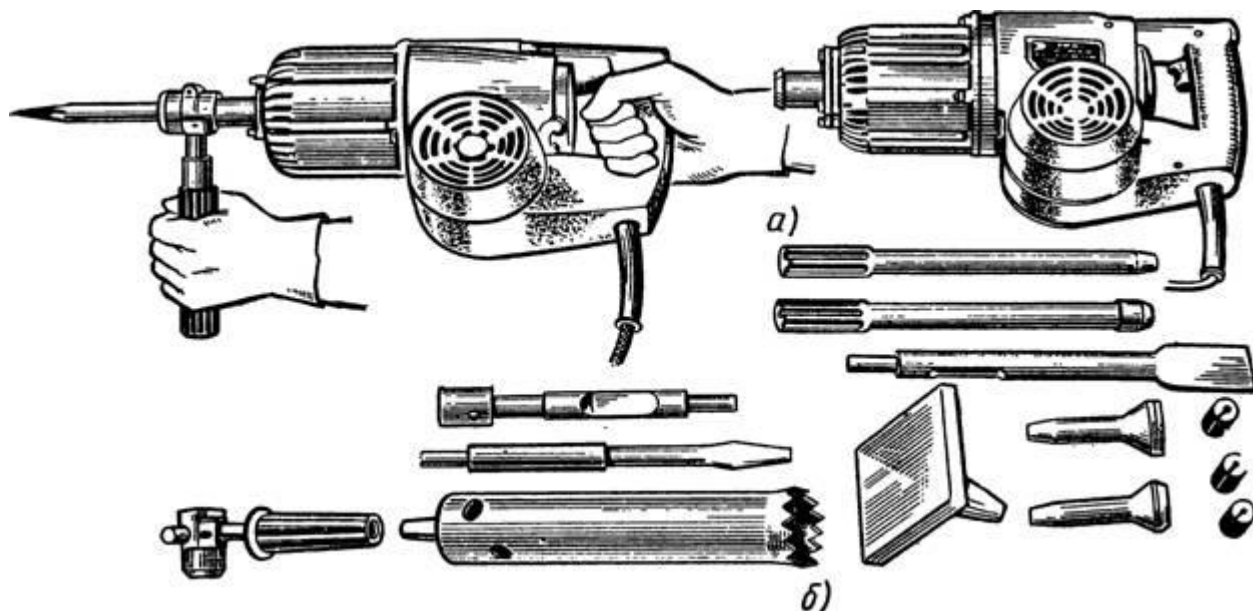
Фугальный электрический молоток, оснащенный рабочими инструментами и поворотной рукояткой (а) и вариант его комплекта (б)
